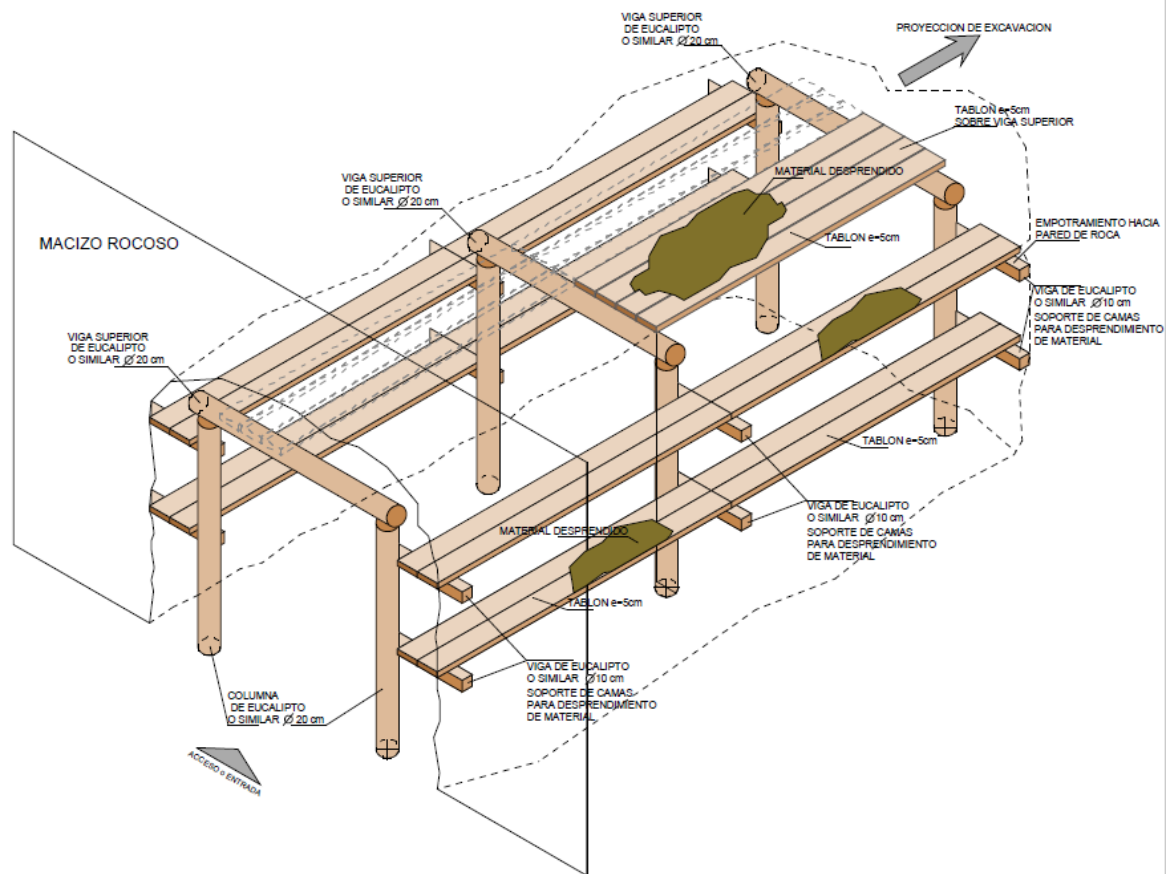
Axonometría del diseño de fortificación propuesto.
